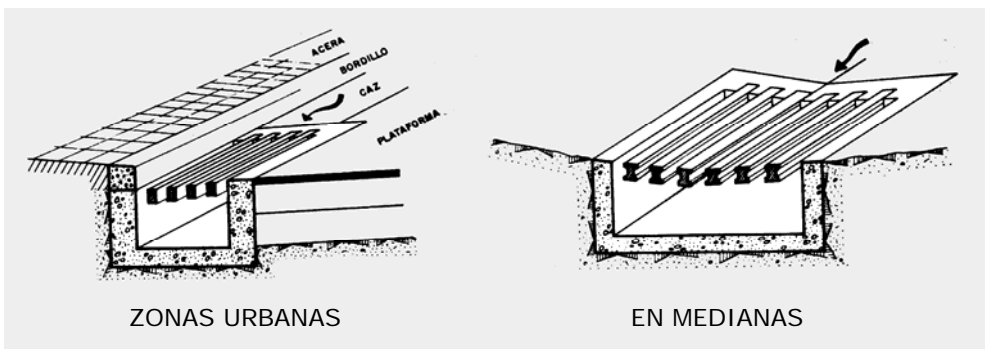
Tipos de sumideros horizontales empleados en carreteras (5.1-IC)
